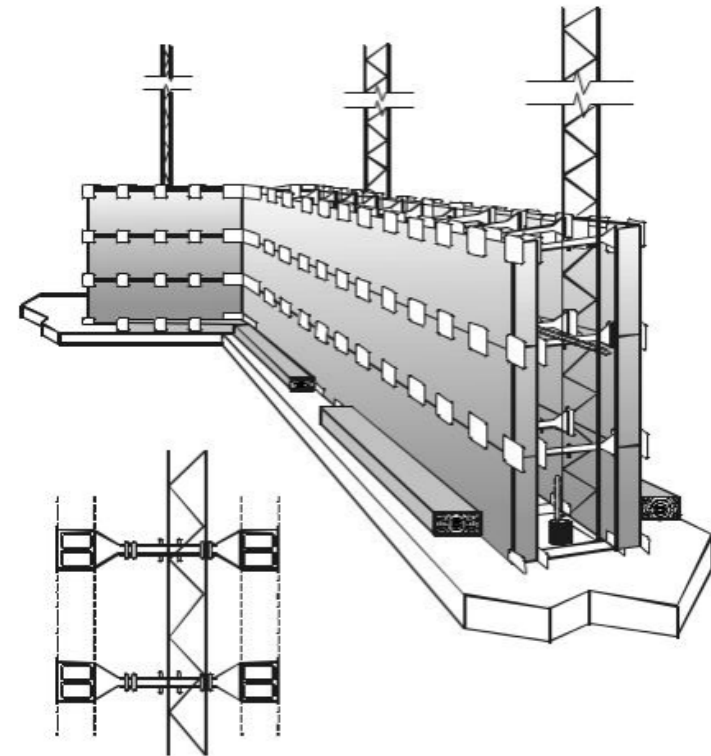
Установка опалубки і арматури першого ярусу бетонуванні (стійки і горизонтальні прогони кріплення не показані)
